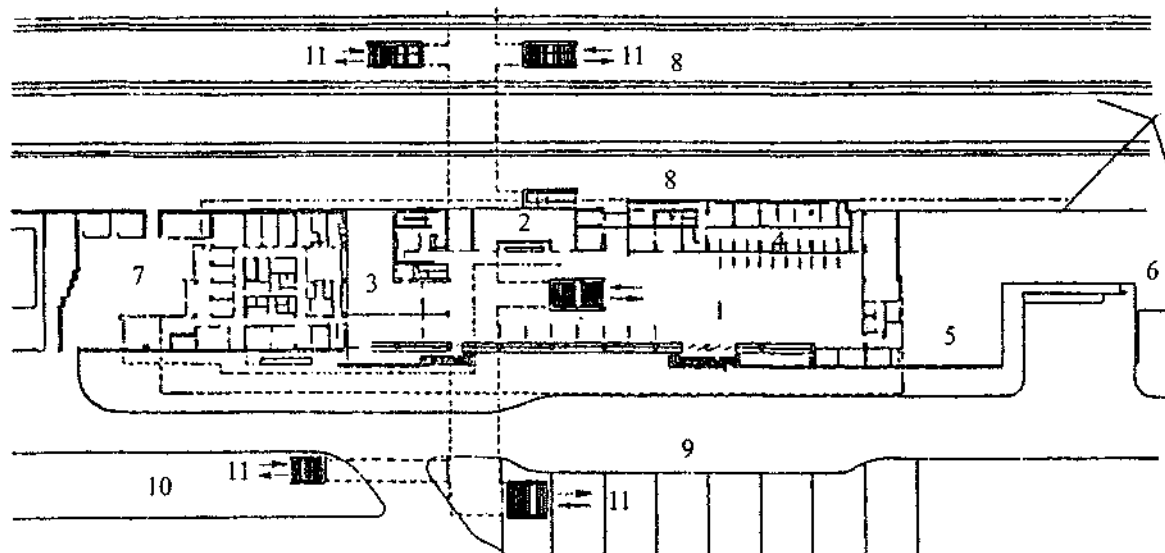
Совмещенный узел пересадки метрополитен - железная дорога
